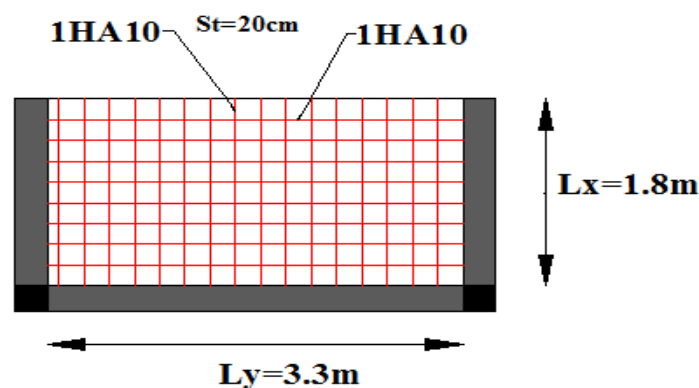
Schéma de ferrailage de la dalle sur 3 appuis
